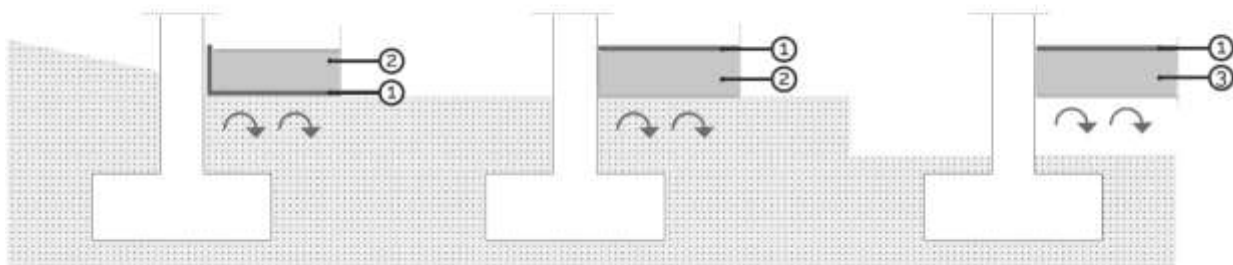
Colocación de la barrera bajo solera (izda.) sobre solera (centro) y sobre forjado (dcha.)
